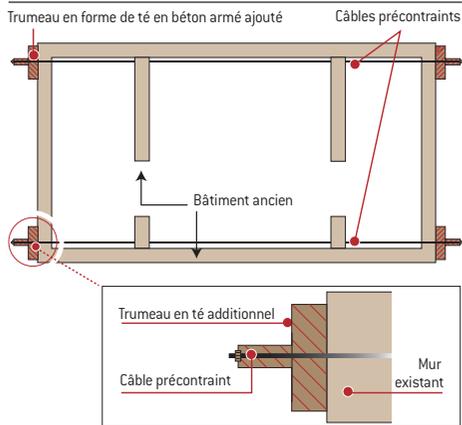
Exemple de renforcement par ajout de murs en béton à l'extérieur + serrage par précontraint (vue en plan)
